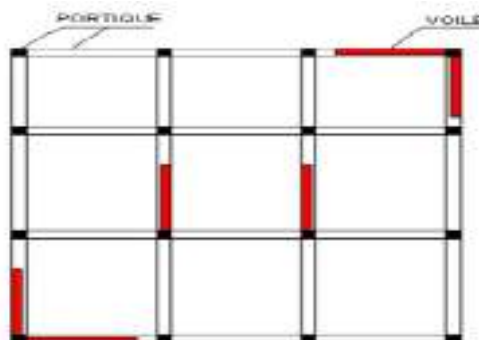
Structure « mixte » avec des murs porteurs couplés à des portiques
